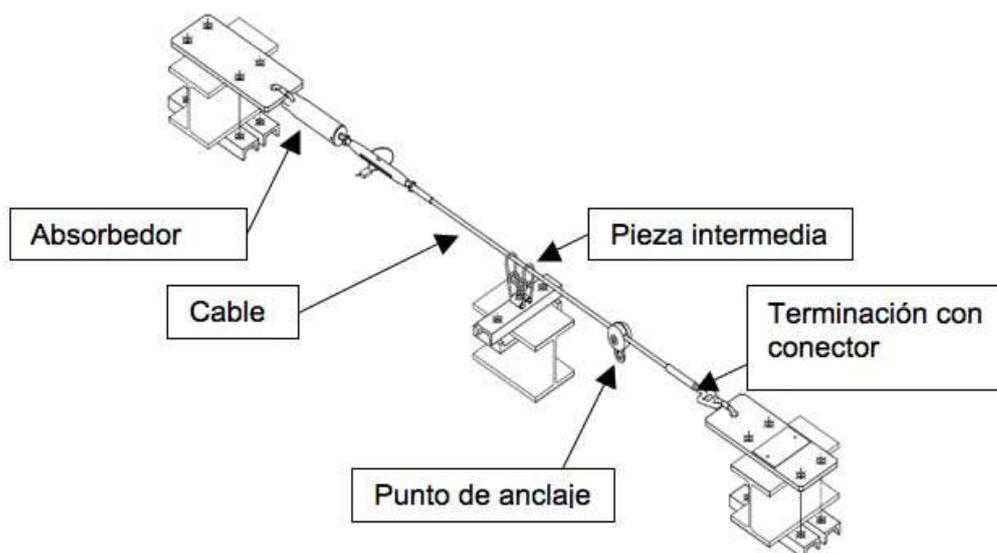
Partes de una línea de anclaje flexible horizontal.
